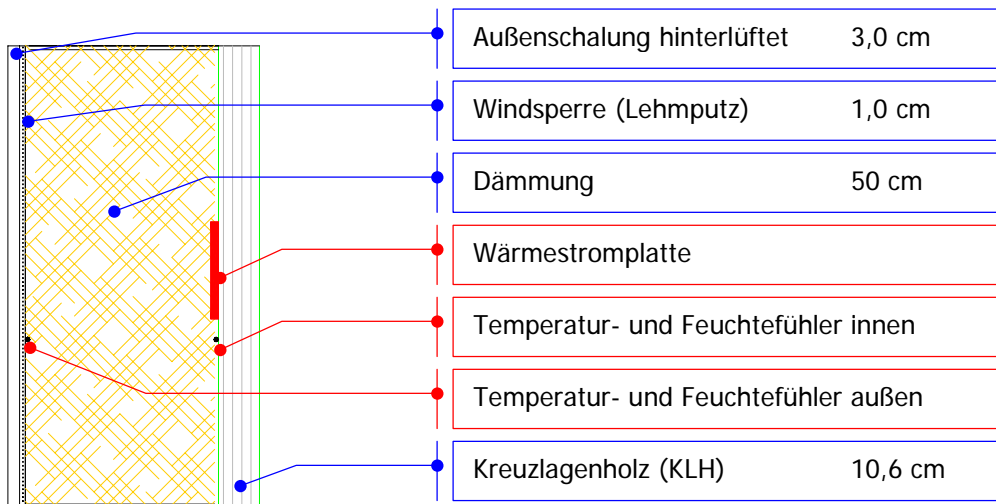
Wandaufbau der Testboxen mit Einbaulage der Fühler
